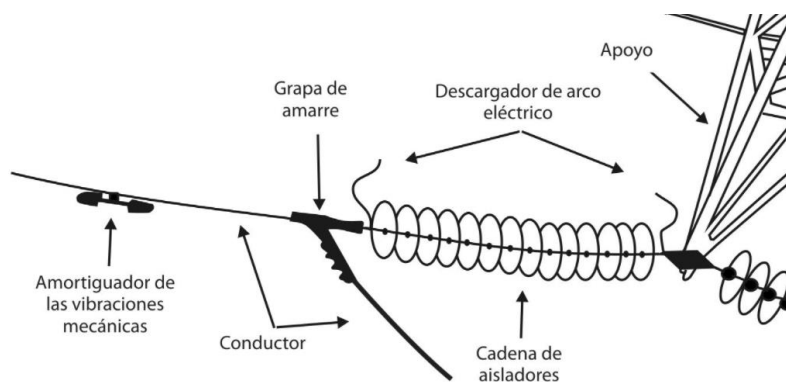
Detalle del montaje de una cadena de aisladores a un apoyo (Fuente: iceditorial.com)
